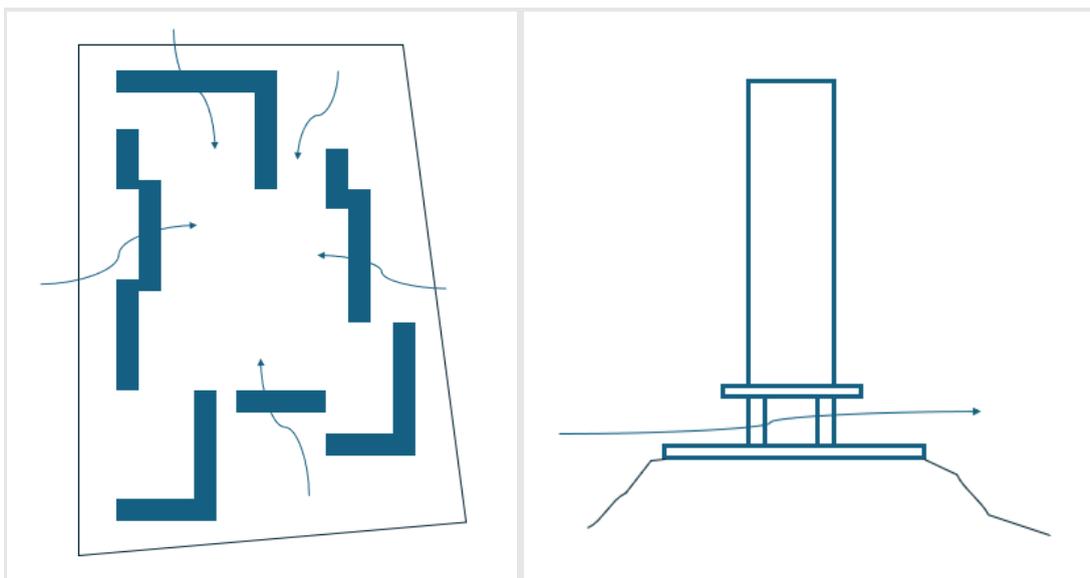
Simón Bolívar. Ingreso libre al centro de manzana y situación en corte de planta baja libre. Fuente: Elaboración propia.
